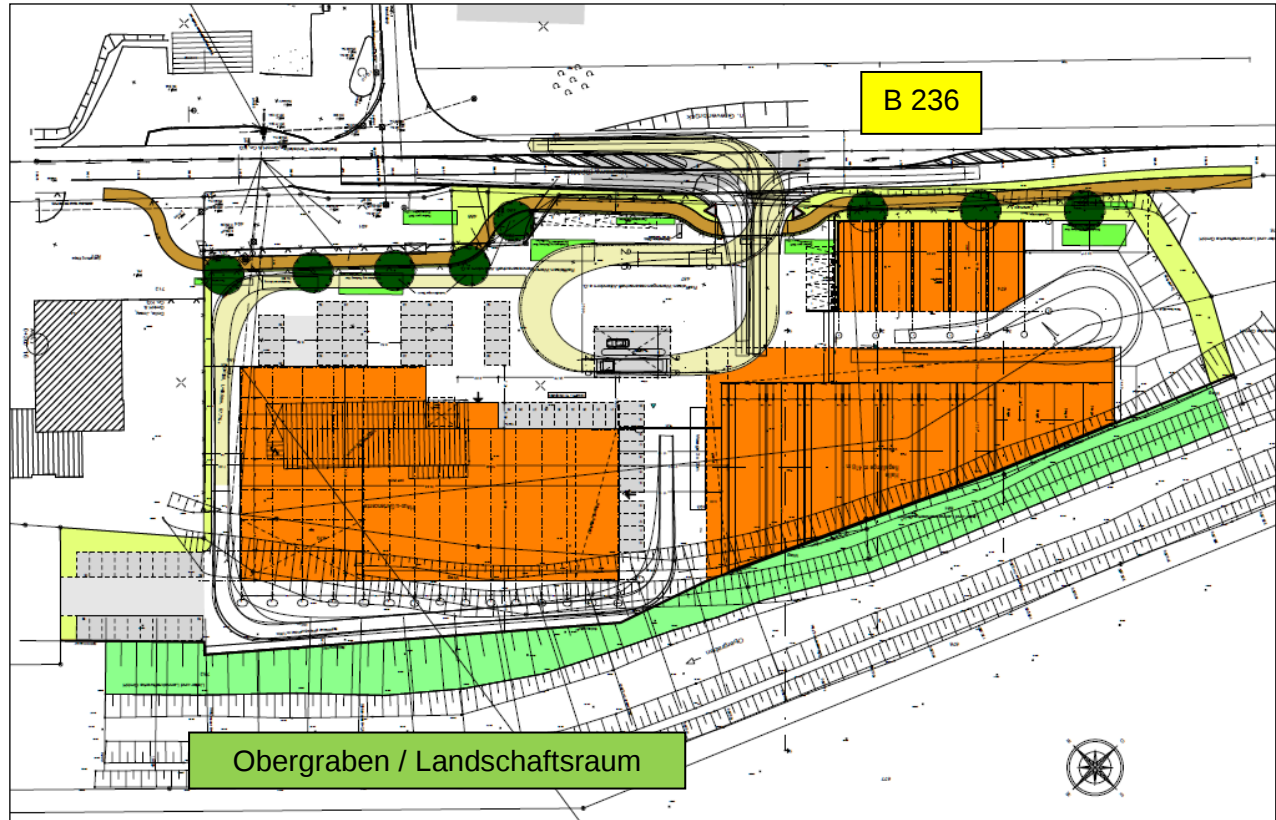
Lageplan mit Standorten der geplanten Betriebsgebäude und der Tankstelle
